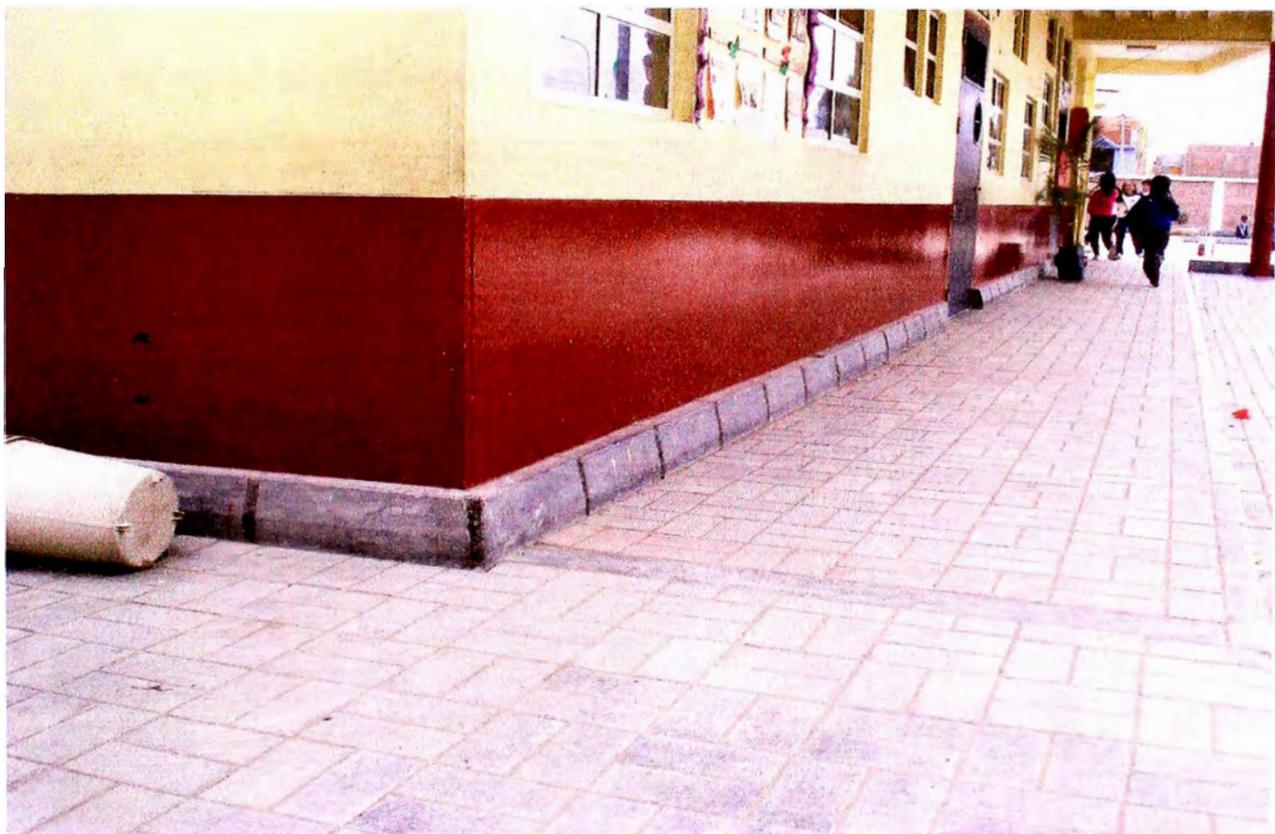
PASADIZO CON PISO DE ADOQUIN Y
